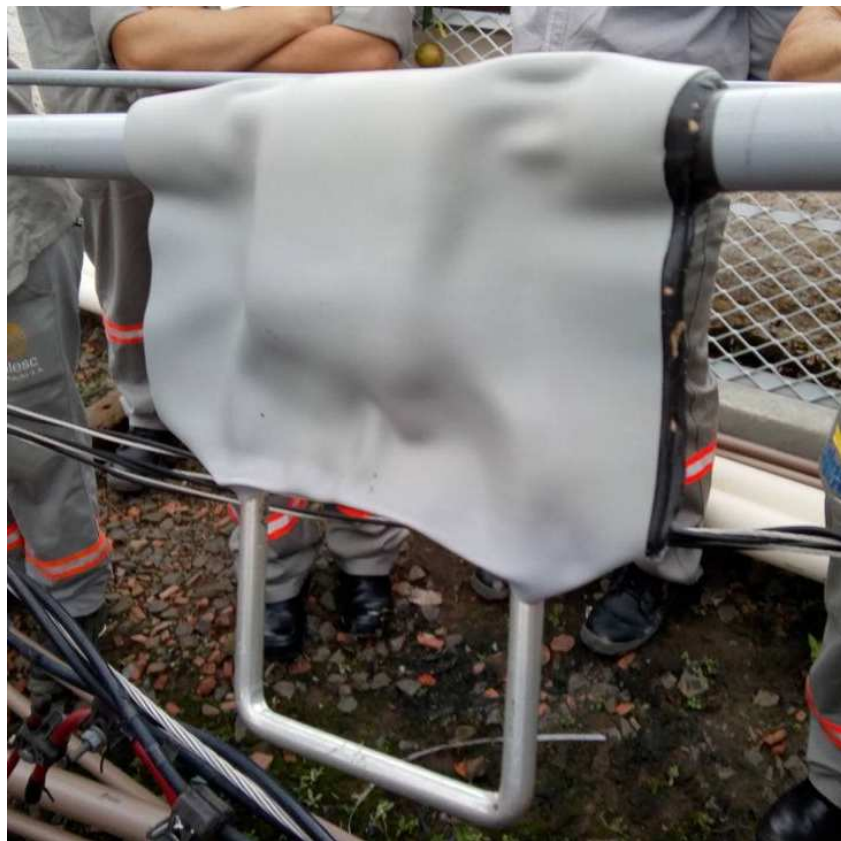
DETALHE DA INSTALAÇÃO DA MANTA DE RECOMPOSIÇÃO DA COBERTURA EM UM ADAPTADOR ESTRIBO CUNHA.
